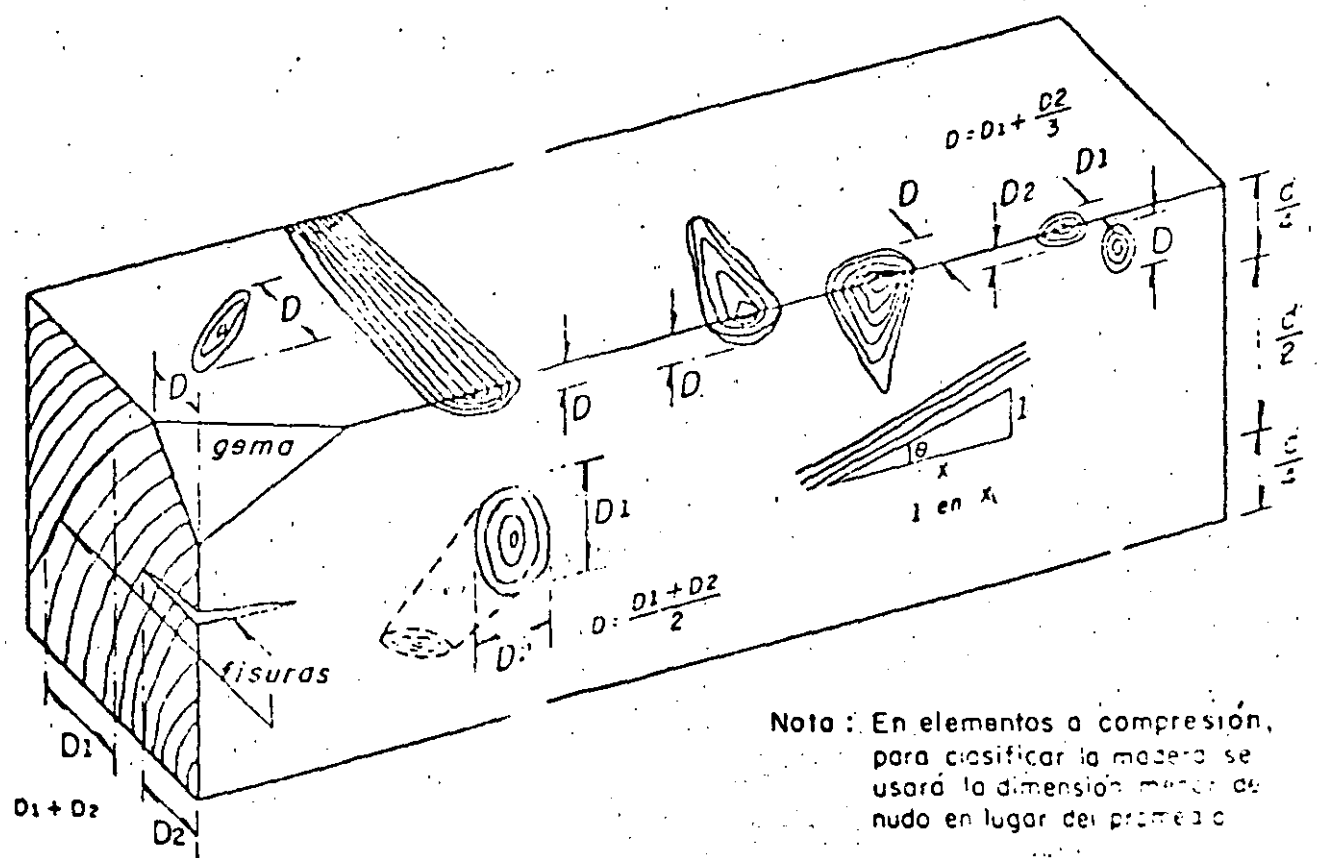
Fig II. Medición de nudo, inclinación de fibra, gema, velocidad de crecimiento y fisuras
